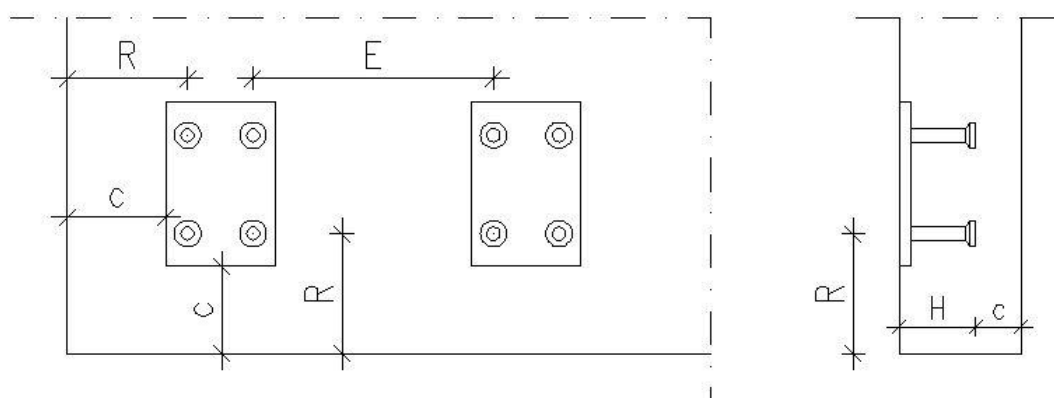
Минимальные расстояния от края бетонной конструкции и между закладными деталями
